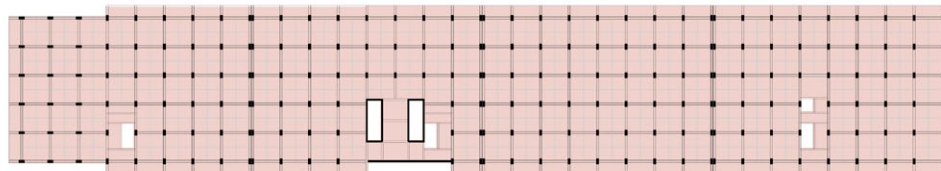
Ámbito de aplicación de cargas en las plantas del entramado.
